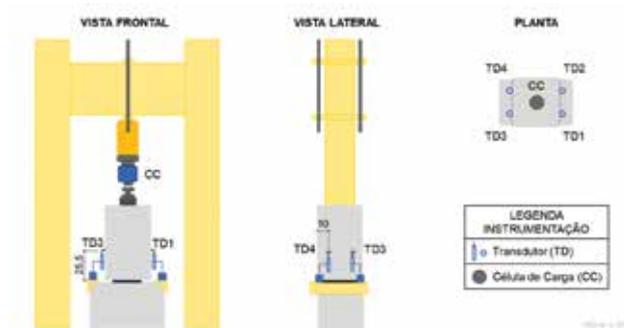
Vistas e planta do esquema de instrumentação dos modelos
